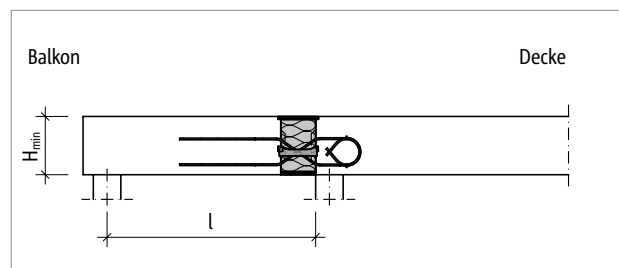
Schöck Isokorb® XT Typ QL-VV: Statisches System (XT Typ QL-VV1 bis VV4)
